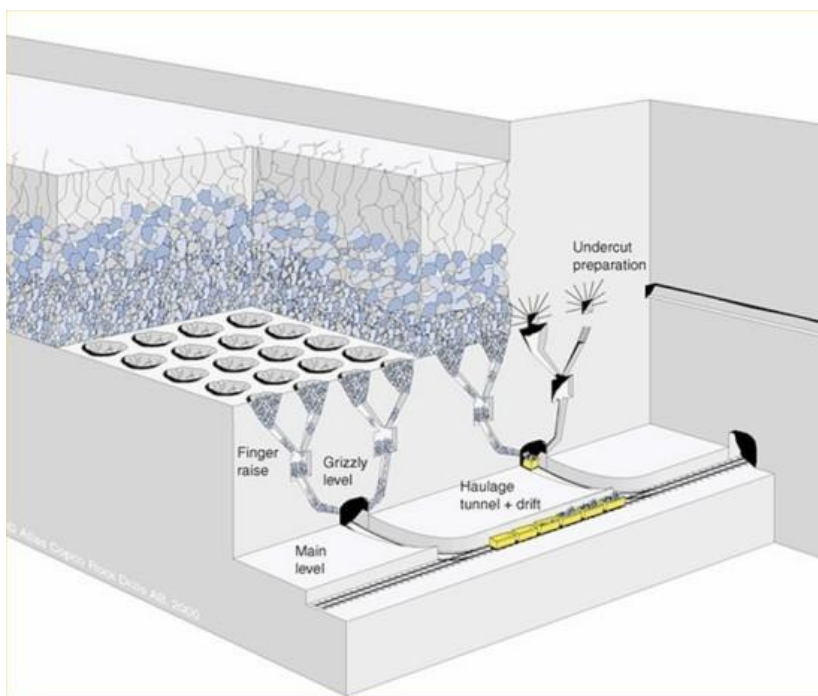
Esquema para planta industrial de extracción minera tipo subterránea con tecnología Block Caving (Fuente: <http://technology.infomine.com/reviews/Blockcaving/>)
